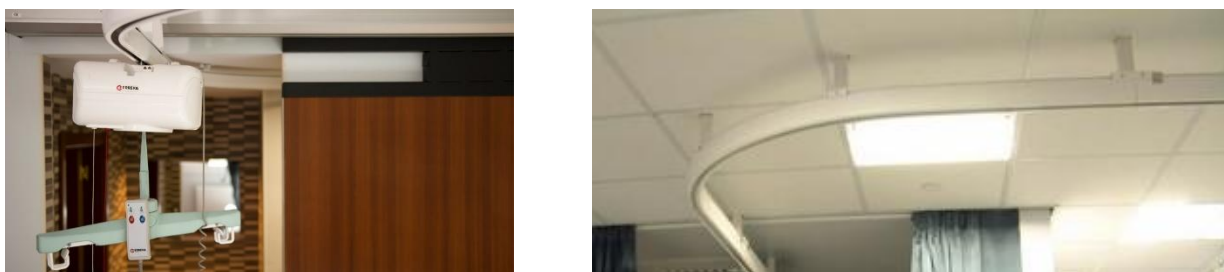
Paso de puerta de la grúa y anclaje a forjado.
